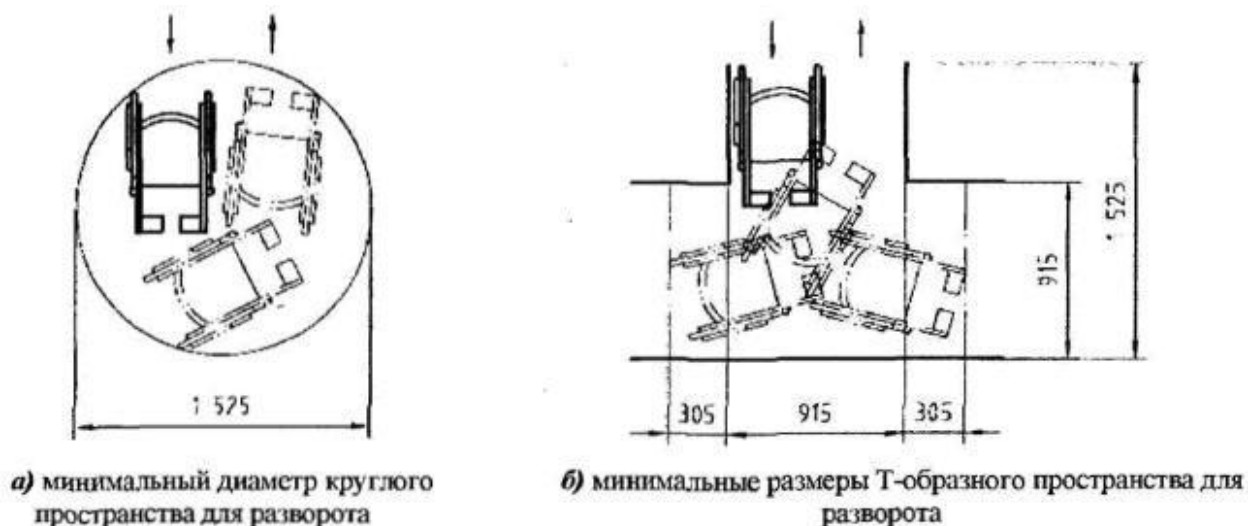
Минимальные размеры пространства для разворота на инвалидных колясках
